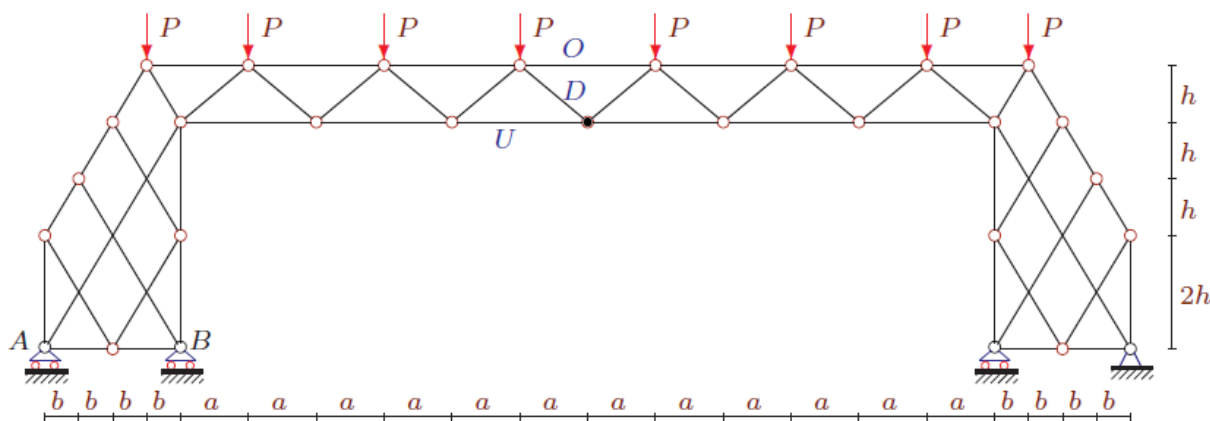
Ферма нагружена по верхнему поясу ригеля
